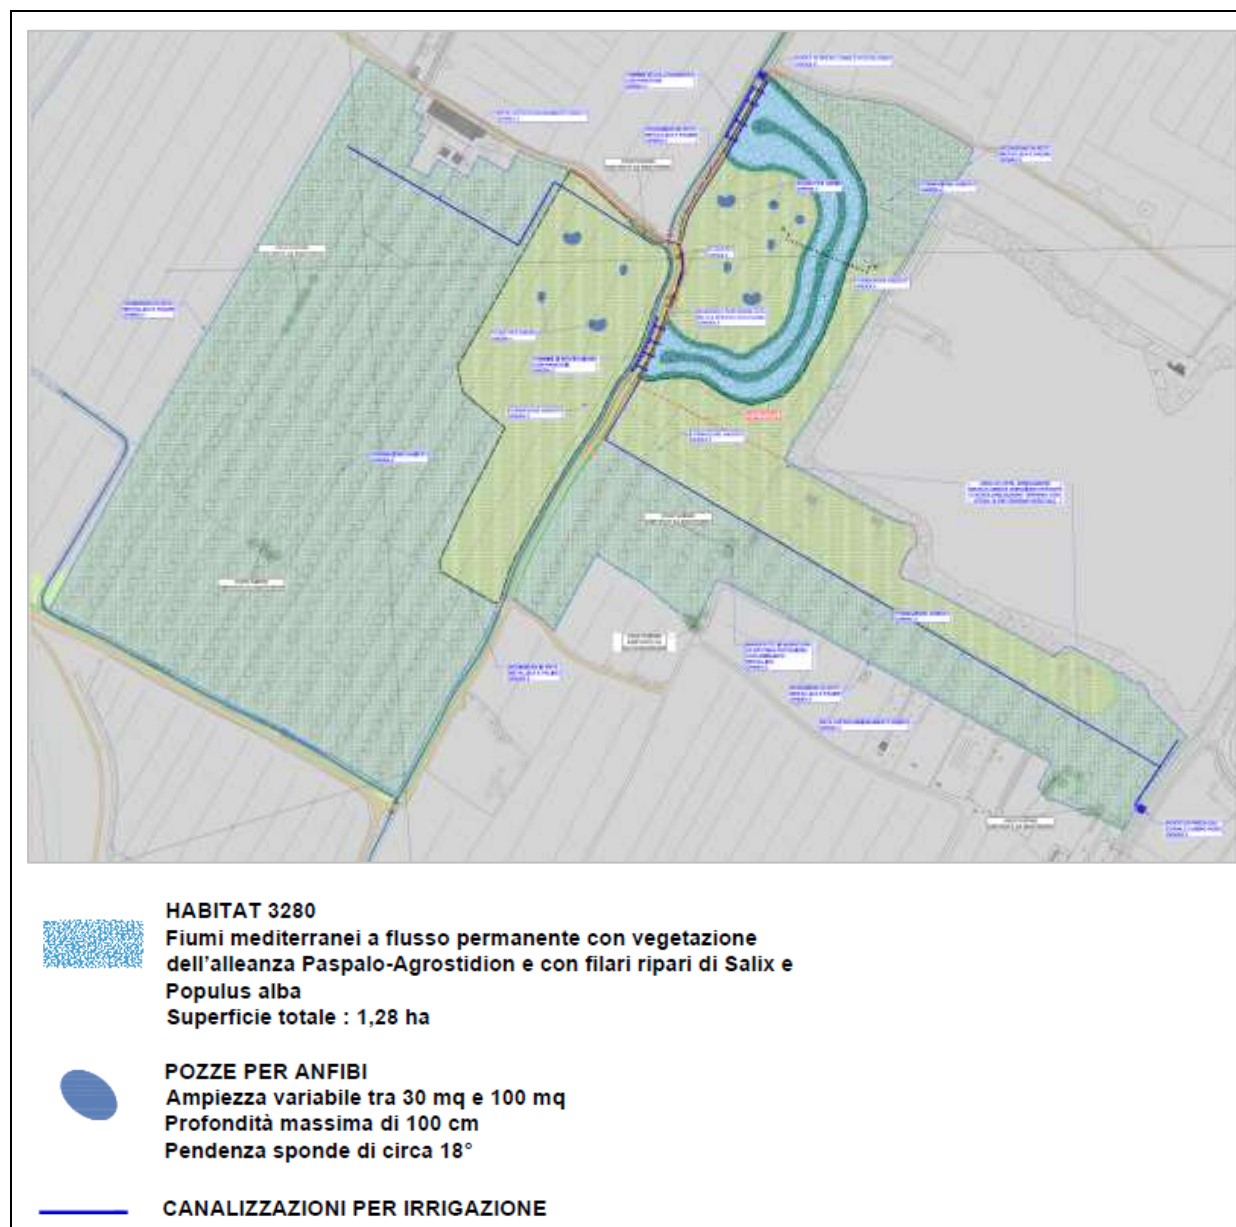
Planimetria generale di progetto (tav. M.P.3)
